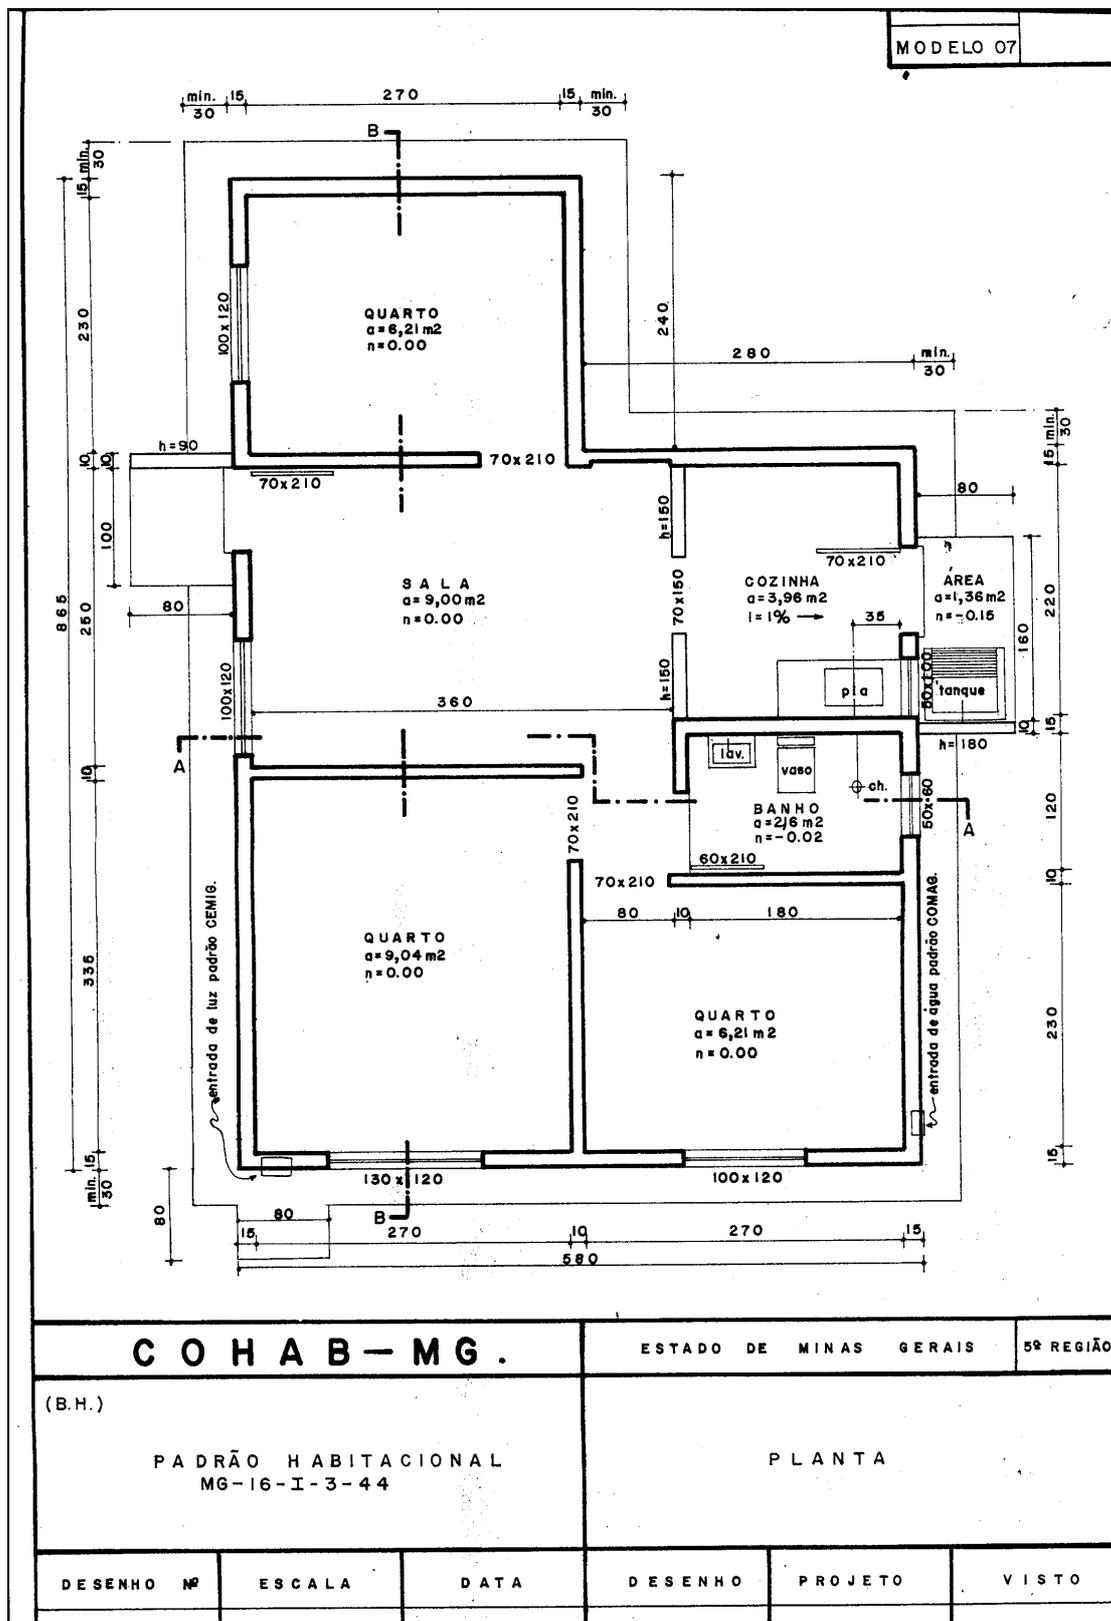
PLANTA BAIXA - CASA DE TRÊS QUARTOS
